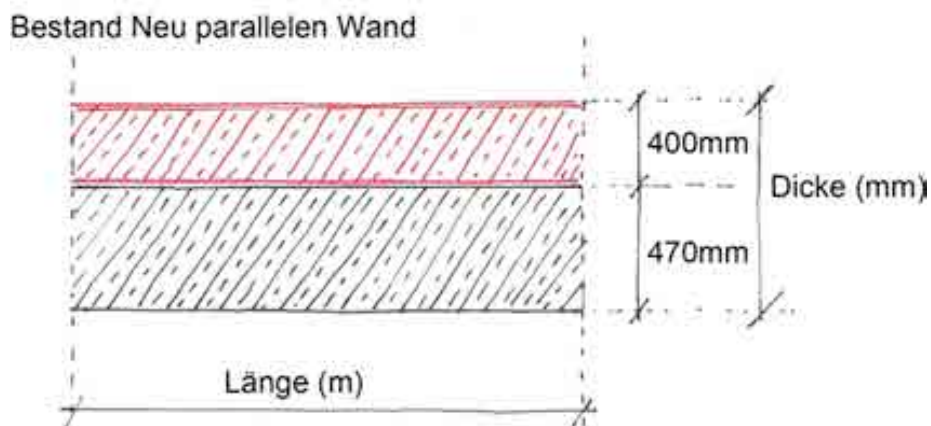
Parallele Wand, Bestand und Neu Stahlbeton
